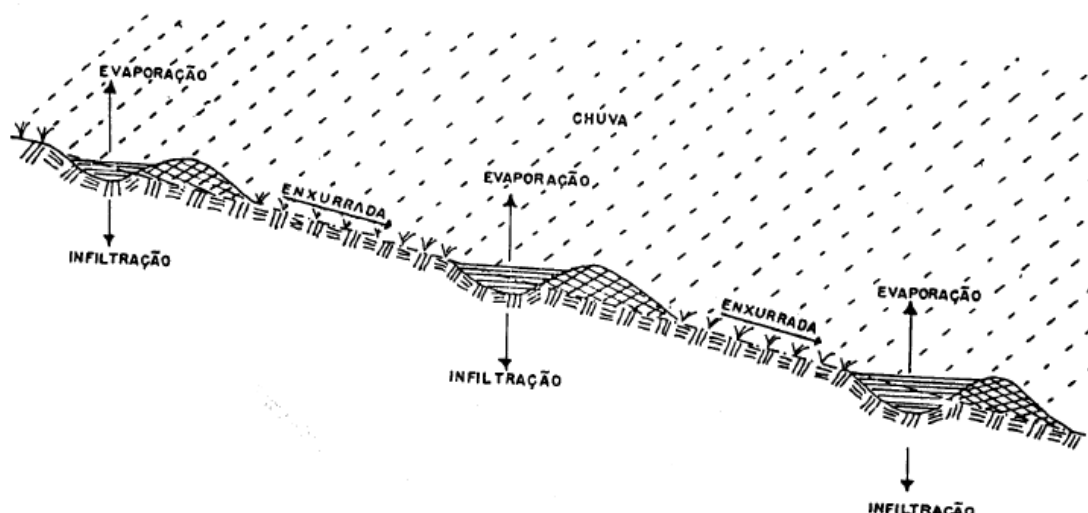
Visão esquemática do terraceamento indicando o seccionamento da rampa com constrição de terraços.
